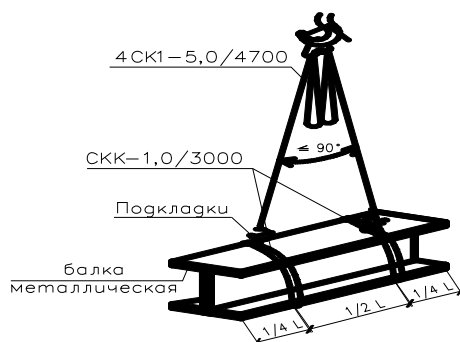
Схема подъема балки перекрытия, покрытия
